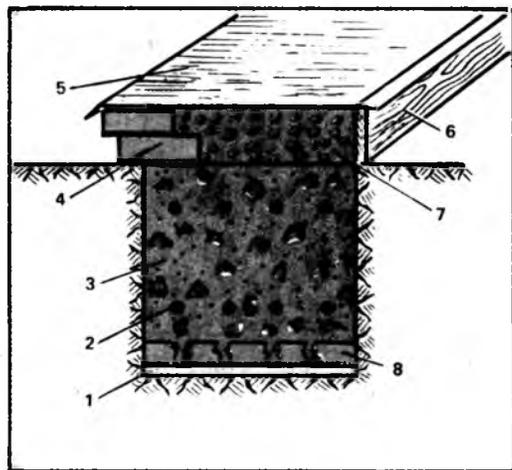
Фундамент: 1 — песок; 2 — железная арматура; 3 — заливка (цемент, песок, кирпичный щебень); 4 — кирпичи напуска; 5 — гидроизоляция; 6 — доска опалубки; 7 — шлакобетон; 8 — половинки кирпичей
